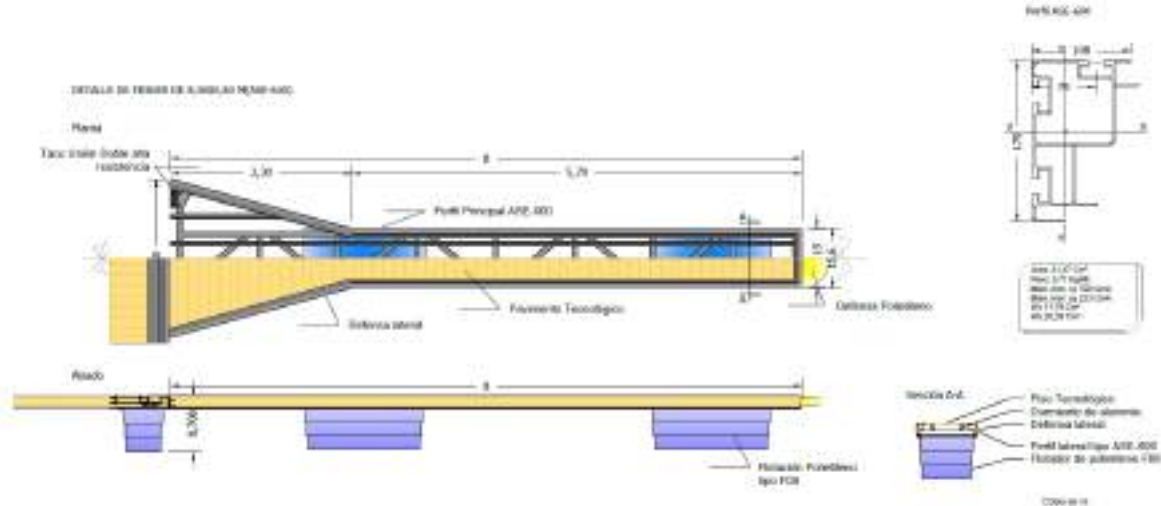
Detalle de planta y sección del finger de 8,00x0,80m para embarcaciones de 10m de eslora.
